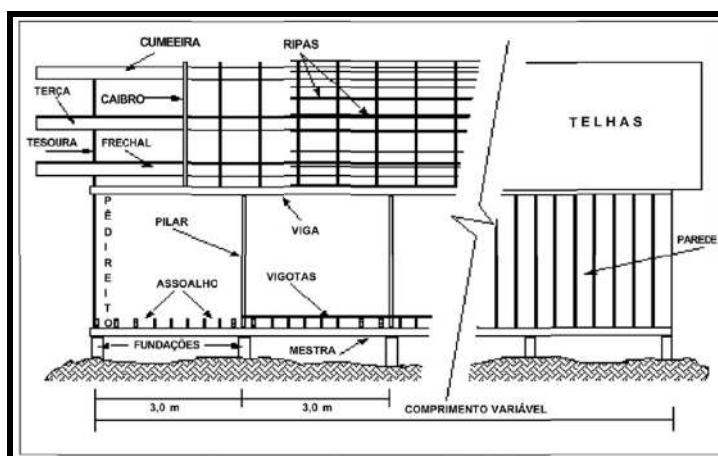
Pavilhão de 6,00 x N metros – vista frontal
